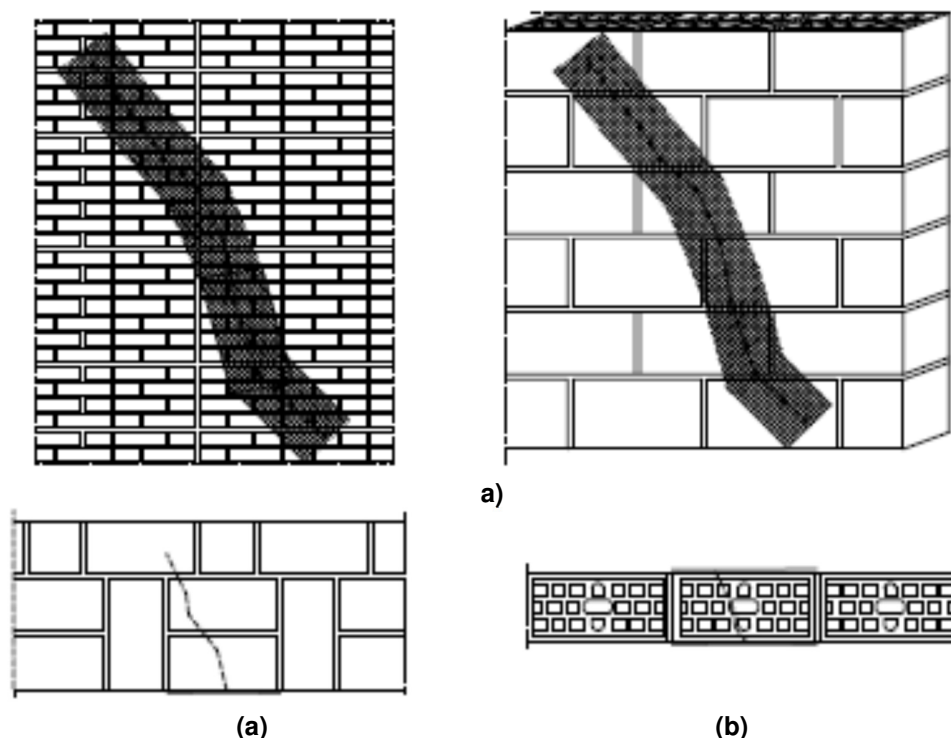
Aplicación de la malla de refuerzo: a) Vista en altura; b) Sección transversal de una fisura no pasante; c) Sección transversal de una fisura pasante.
